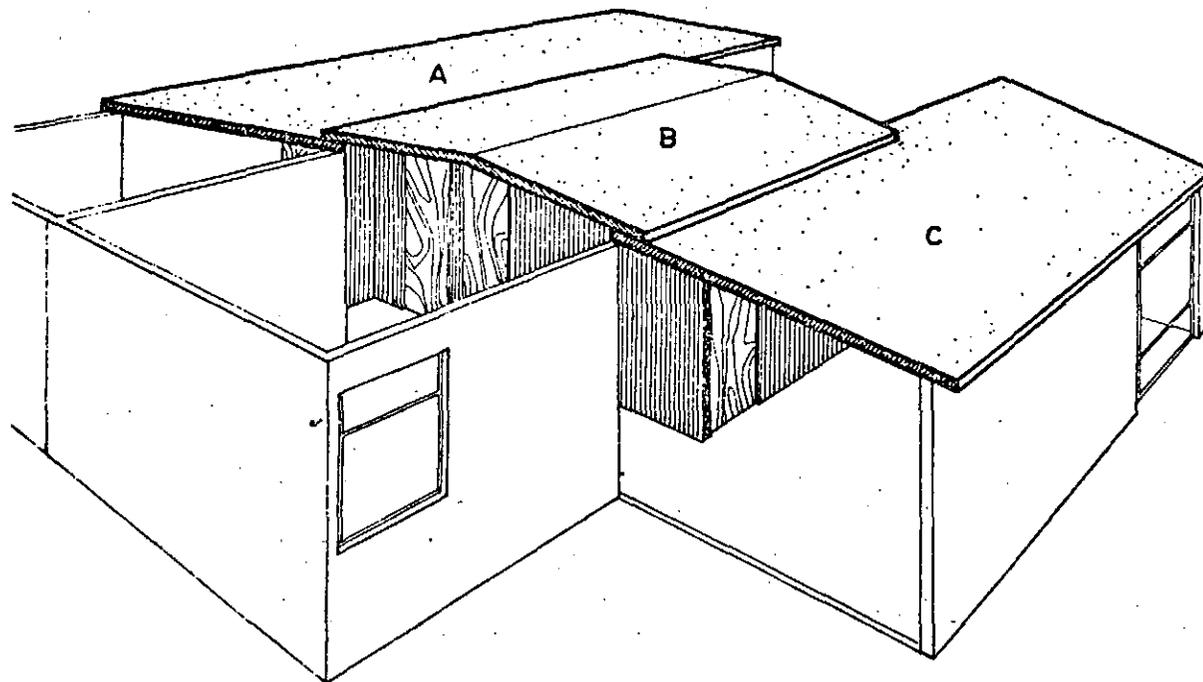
Placas planas pretensadas en dos sentidos de Cimbracret. Aplicaciones en techos de vivienda popular.
